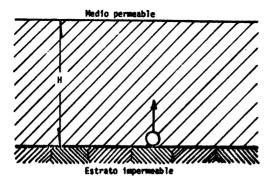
Estrato compresible drenado sólo por una caroa.
